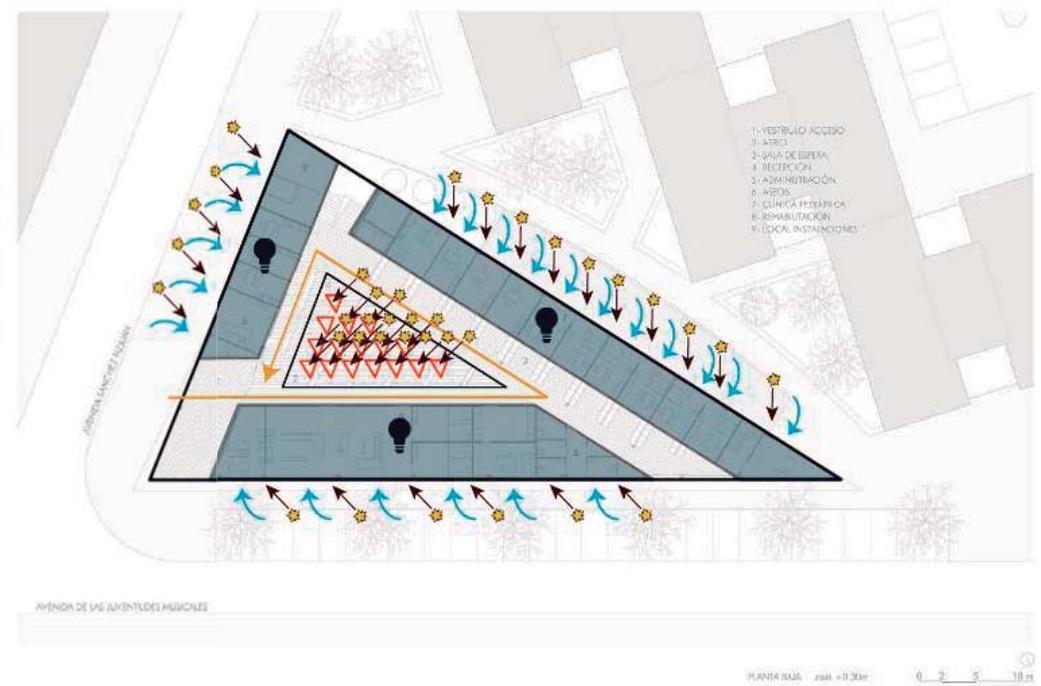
Solución de ventilación e iluminación natural de las plantas arquitectónicas. Autor: A.G.R. Fuente: ArchDaily.
